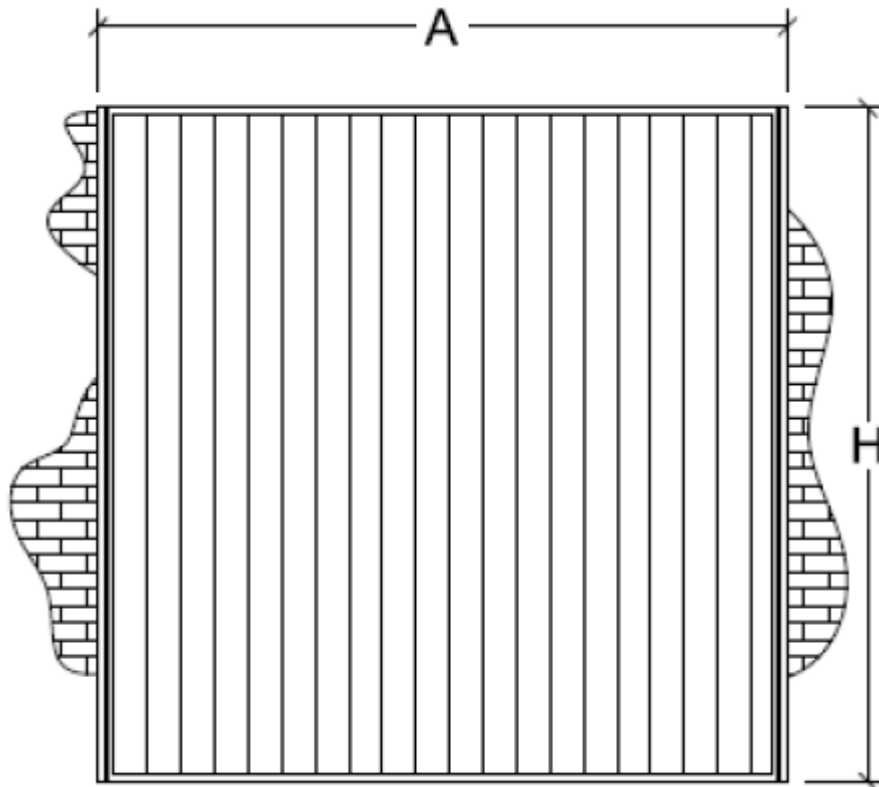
Puerta metálica que se situara en el muro piñón.
